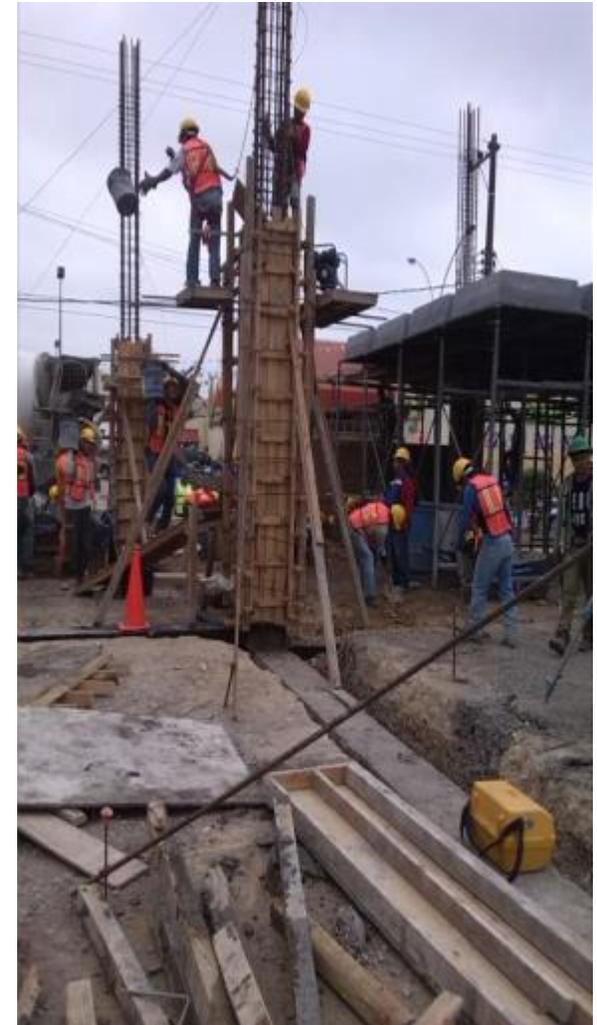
Colado de columna, revisión de nivel hasta donde deberá quedar colada.
